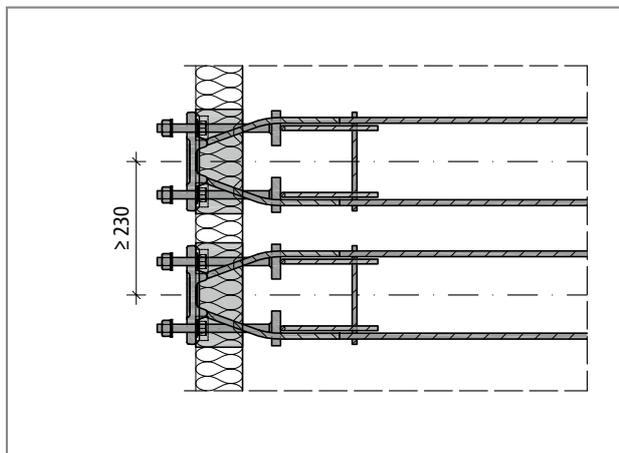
Schöck Isokorb® T Typ SQ mit Stahlschwert: Achsabstand
